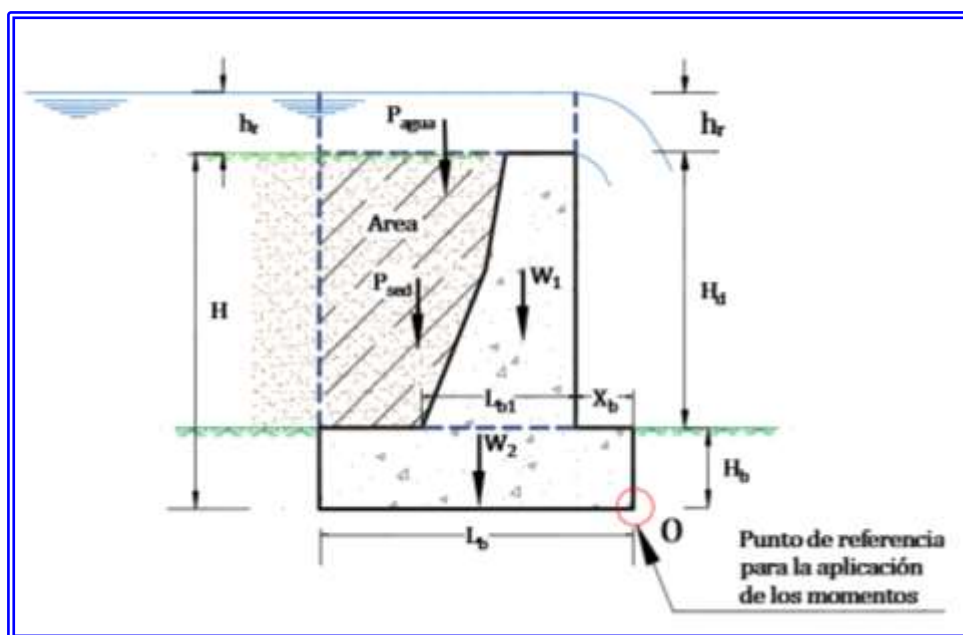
Fuerzas Estabilizantes sobre un diente de una presa abierta tipo peine de concreto armado.-
